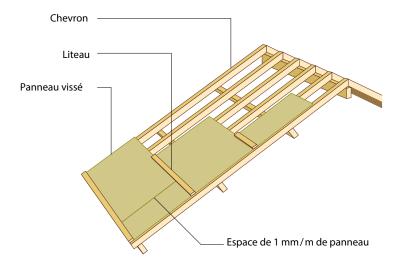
Exemple de contreventement de versants par des plaques à base de bois
